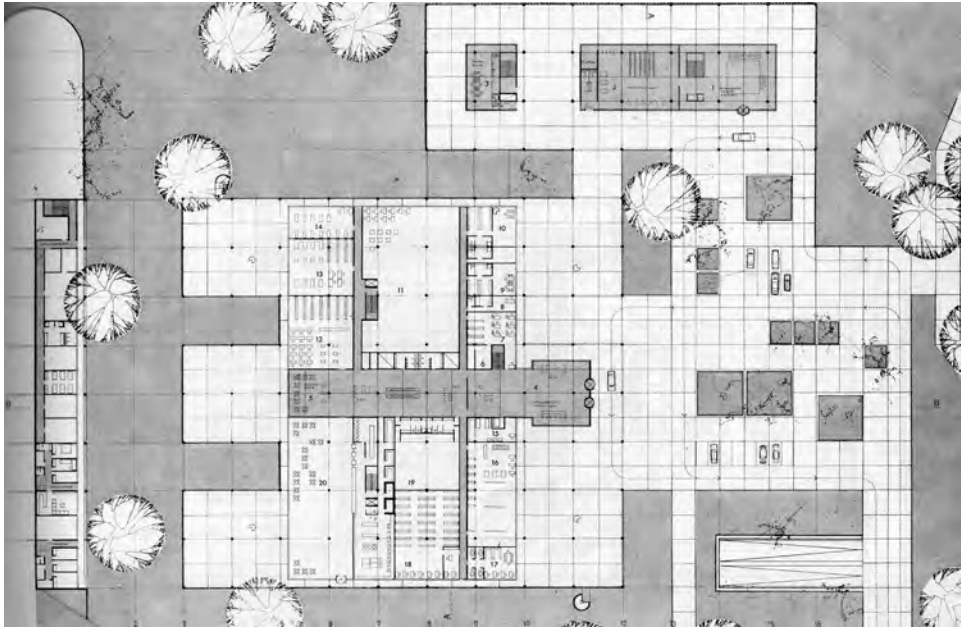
Planungsguppe Stiefdorf: Entwurf Kanzleramtsneubau. Grundriss Erdgeschoss.
